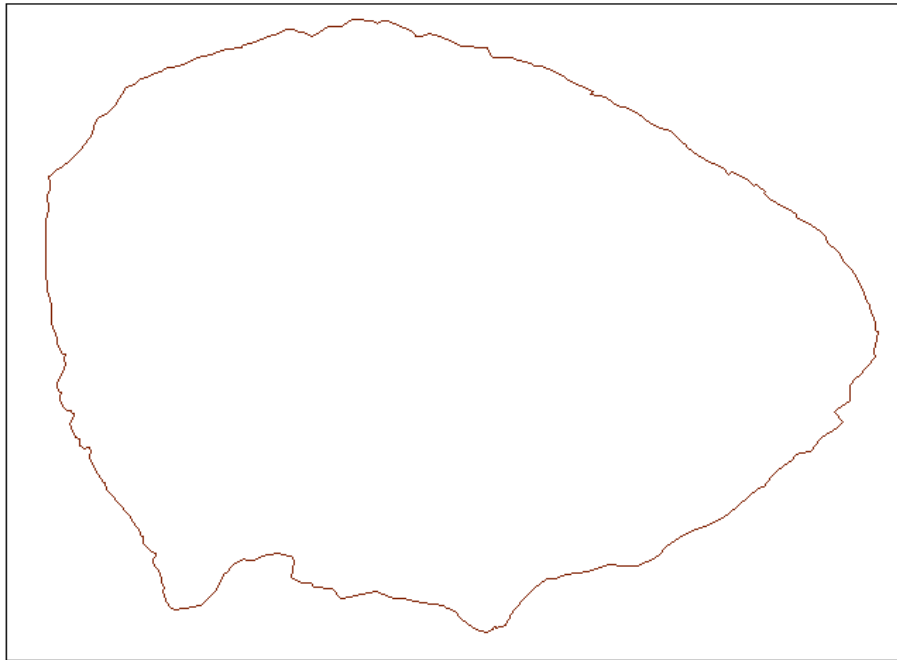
Planta de perímetro do aterro arquivo .dxf.
